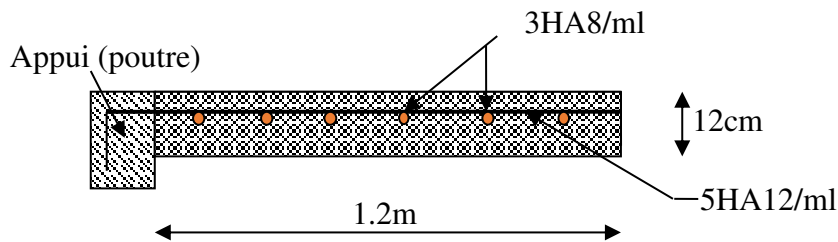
Schéma de ferrailage d'une dalle sur un appui appuis.
